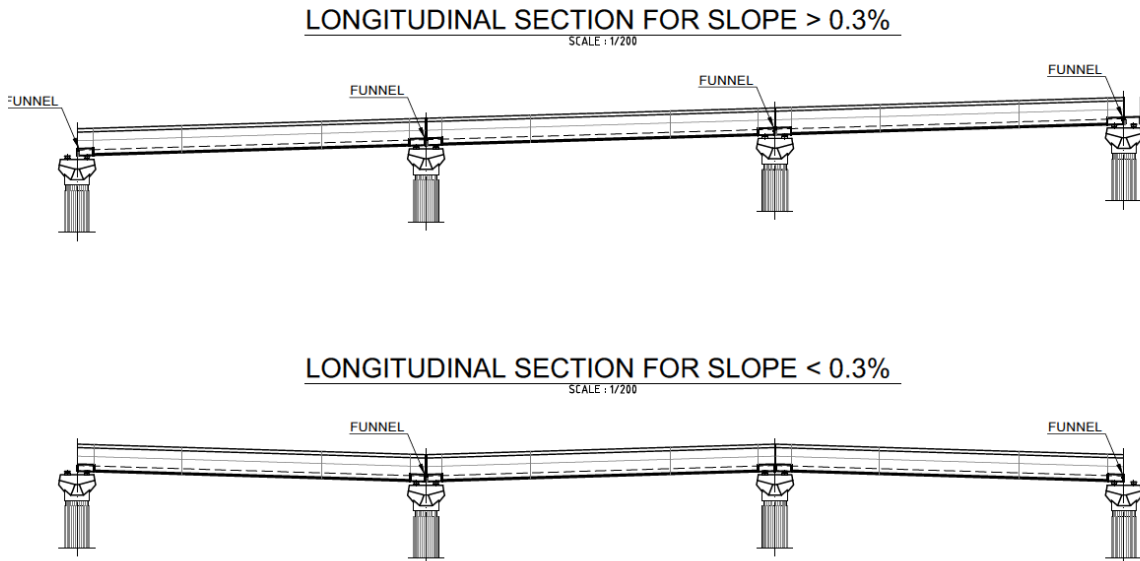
Drenaje longitudinal en tramos del viaducto. Fuente: Elaboración propia
